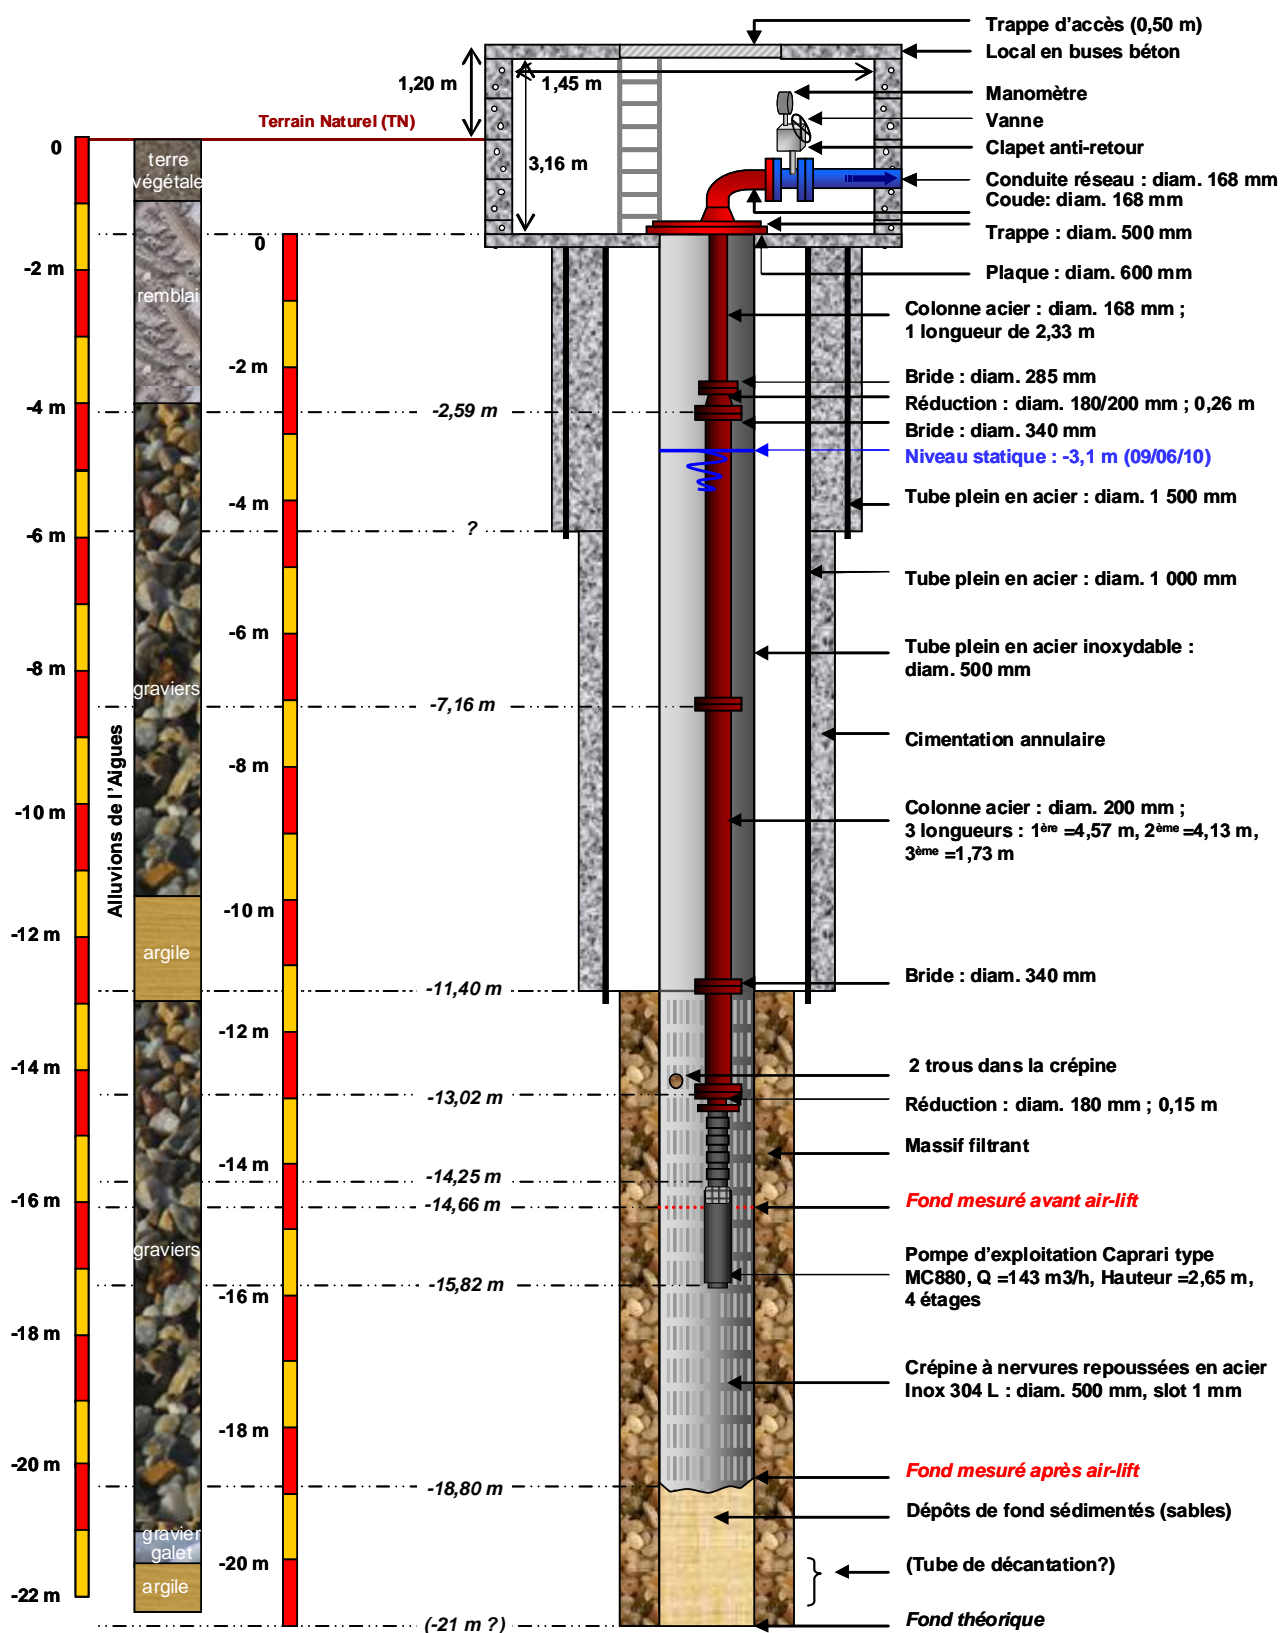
Coupe technique du forage exploité d'après l'inspection vidéo
